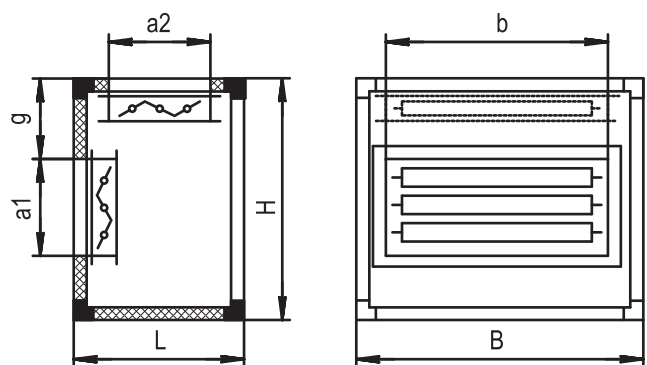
Блок приемно-смесительный с двумя клапанами внутри
